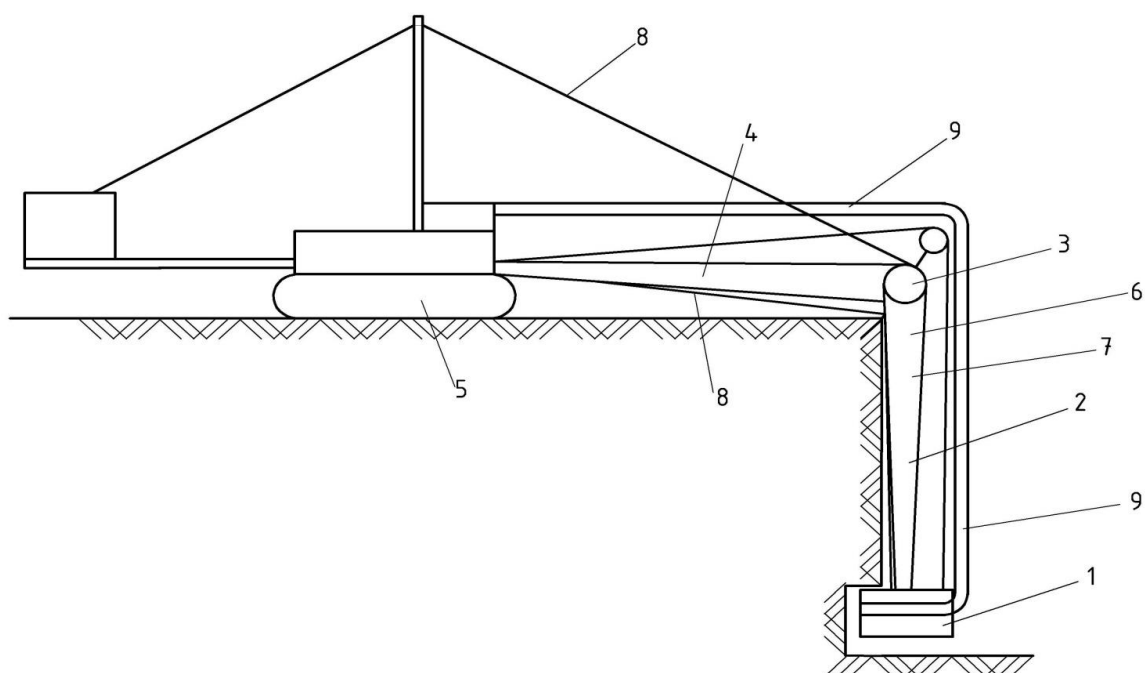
Механическая подрезка уступа фрезерным рыхлителем: 1 – фрезерный рыхлитель; 2 – стрела; 3 – шарнир; 4 – упор; 5 – тележка; 6 – электродвигатель; 7 – редуктор; 8 – поддерживающий трос; 9 – труба
